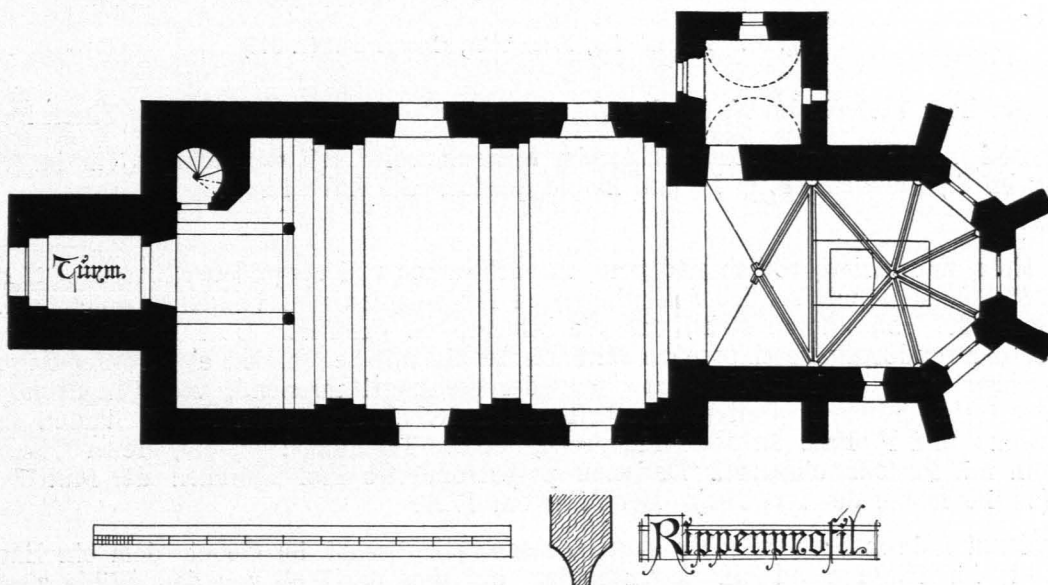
Frauenhofen, Filialkirche, Grundriß 1 : 200 (S. 343)
